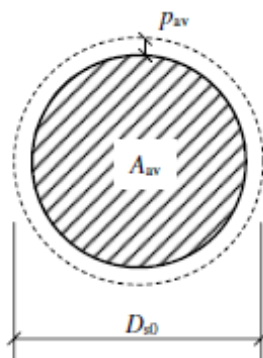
Perda de secção média das armaduras corroídas. (adaptado de (Zhang et al. 2014))
